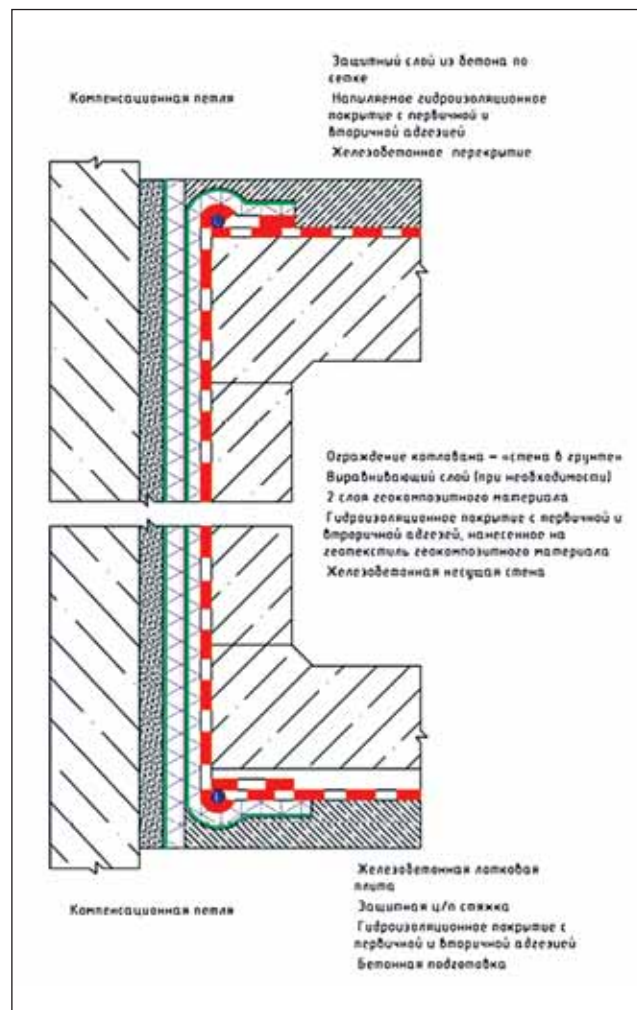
Схема устройства гидроизоляционной системы при открытом способе работ без пауз для обратной засыпки грунтом [9]
